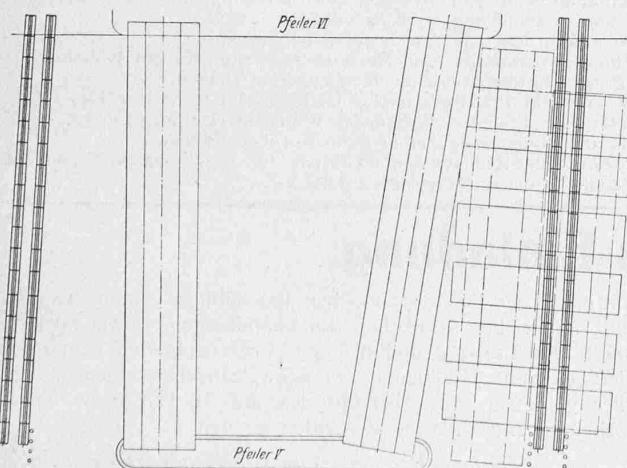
Grundriss zu Abb. 48. — Masstab 1:500.
